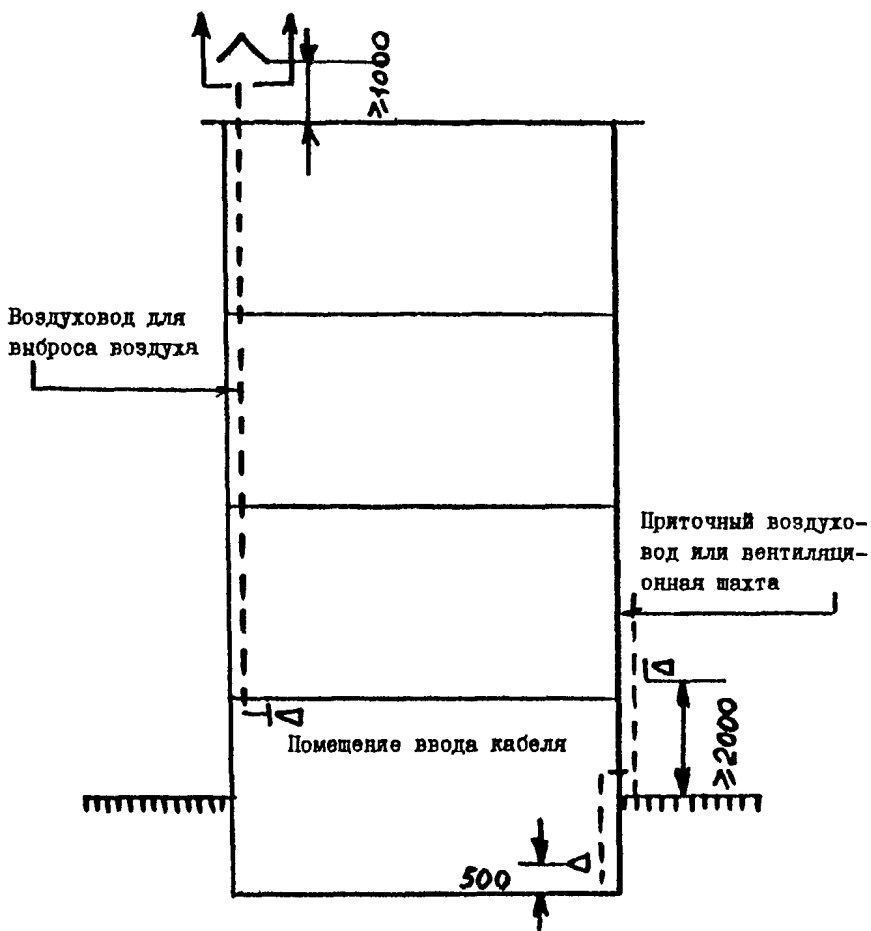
Рис. I Принципиальная схема вентиляции помещения ввода кабеля.
